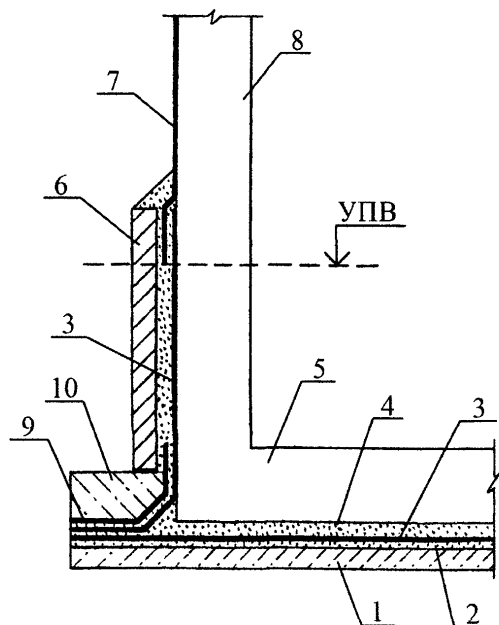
Оклеечная гидроизоляция тоннеля при наличии подземных вод
